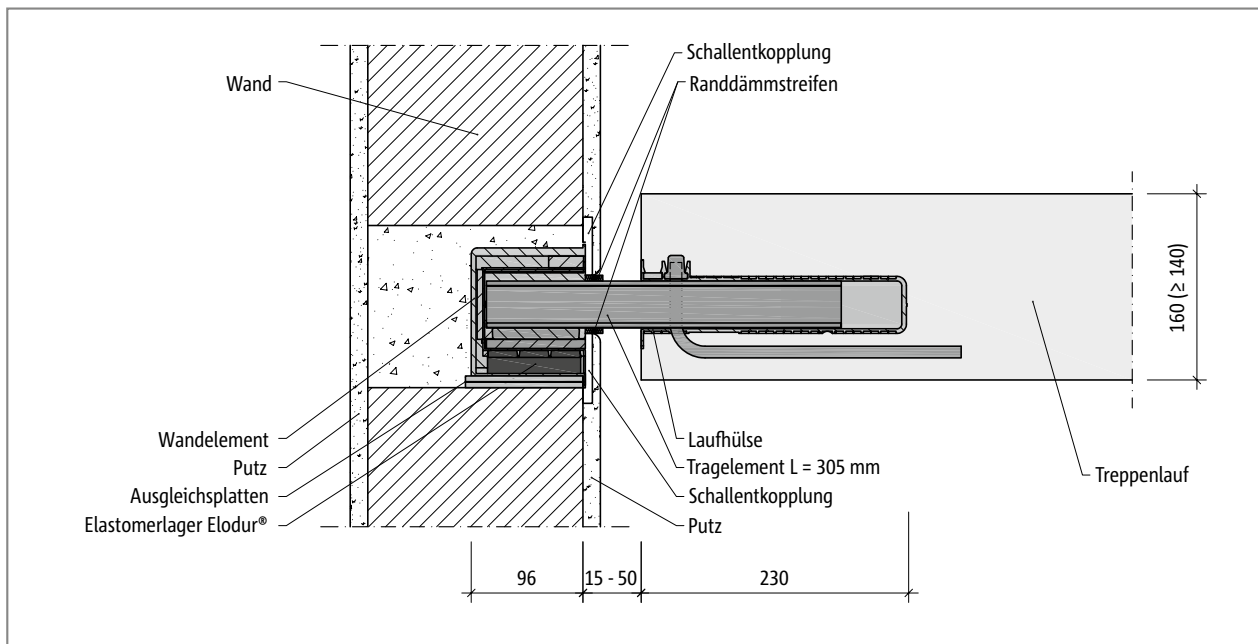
Schöck Tronsole® Typ Q-FV oder Q-A2: Einbauschnitt mit Elementtreppenlauf
